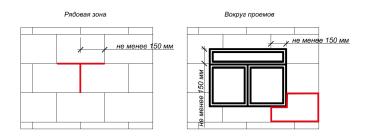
Схема установки плит на плоскости фасада и вокруг проемов
